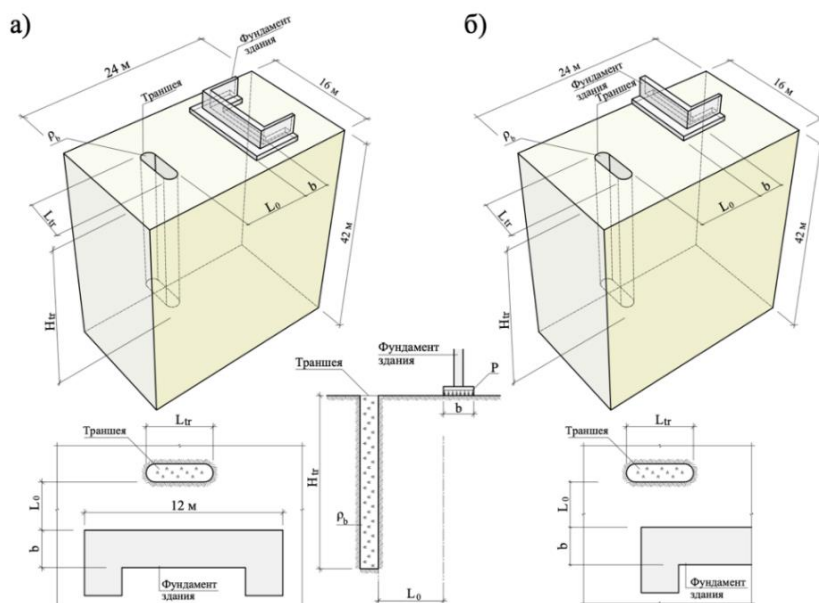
Схемы к расчету осадки фундамента, вызванной разработкой траншеи:
